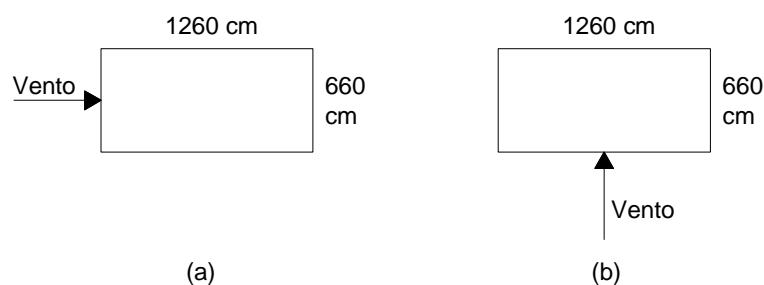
Esquema em planta para o vento atuando na direção: a) longitudinal e b) transversal.
